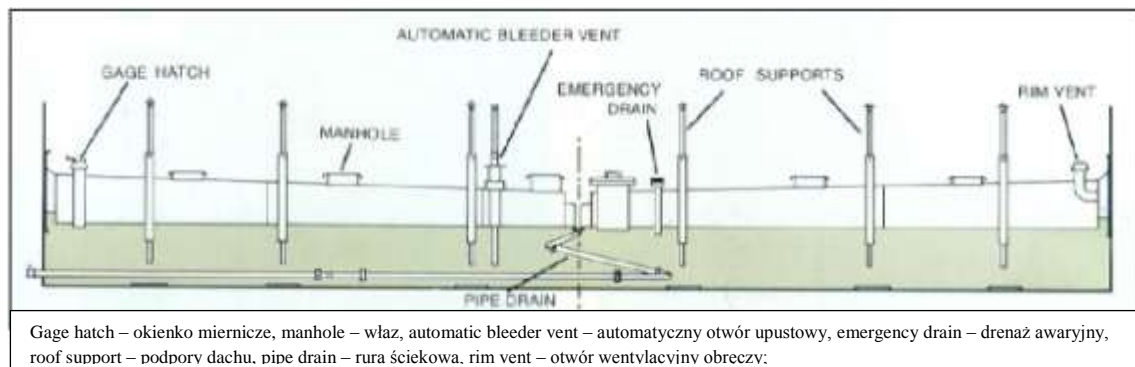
Typowy zbiornik z pływającym dachem typu pontonowego
